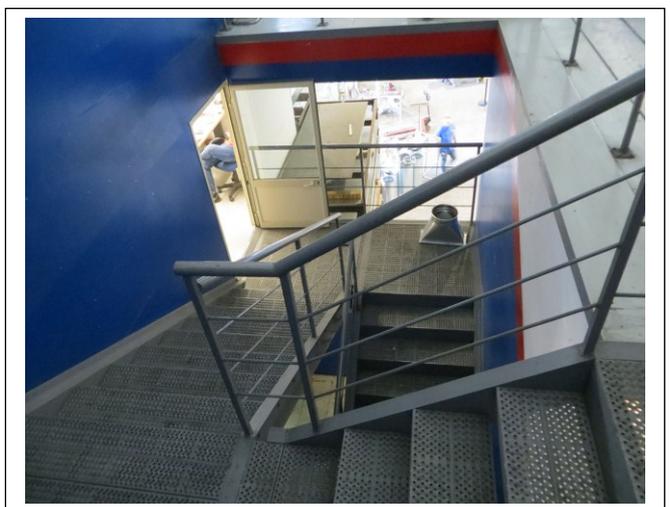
Scala di servizio di accesso al piano ammezzato e al primo piano.
